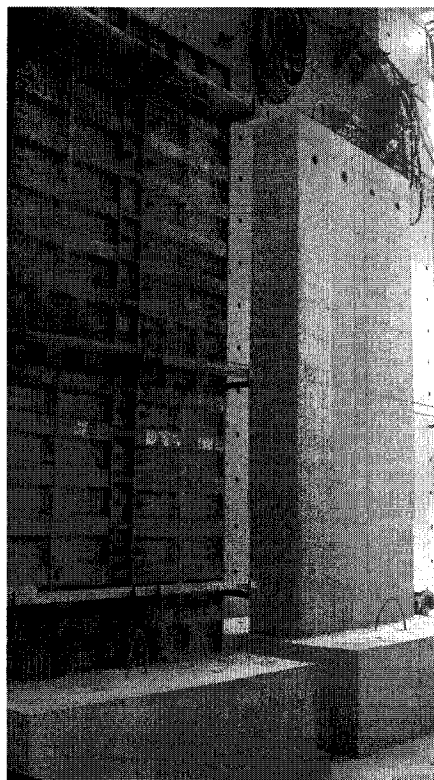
Photo du pilier 3 décoffré et du pilier 4 avant sa coulée
